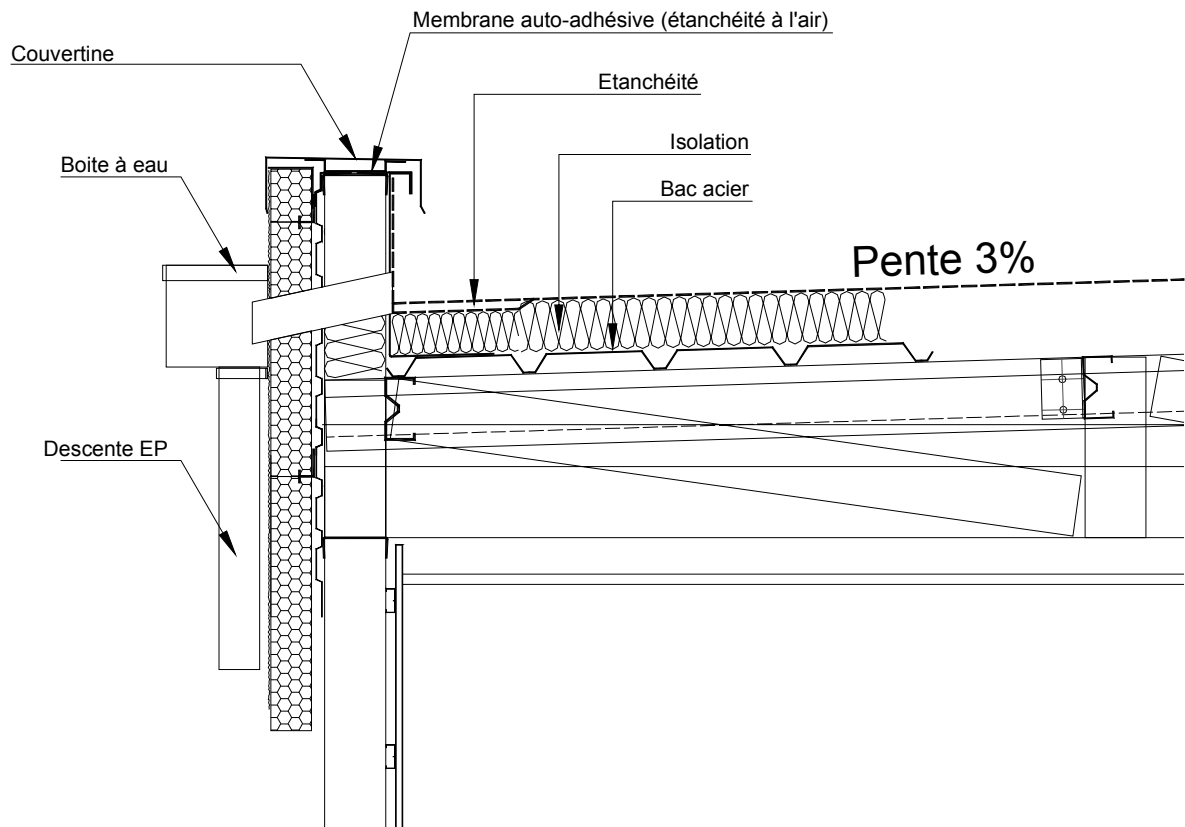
Coupe verticale sur acrotère (étanchéité sur bac acier)
